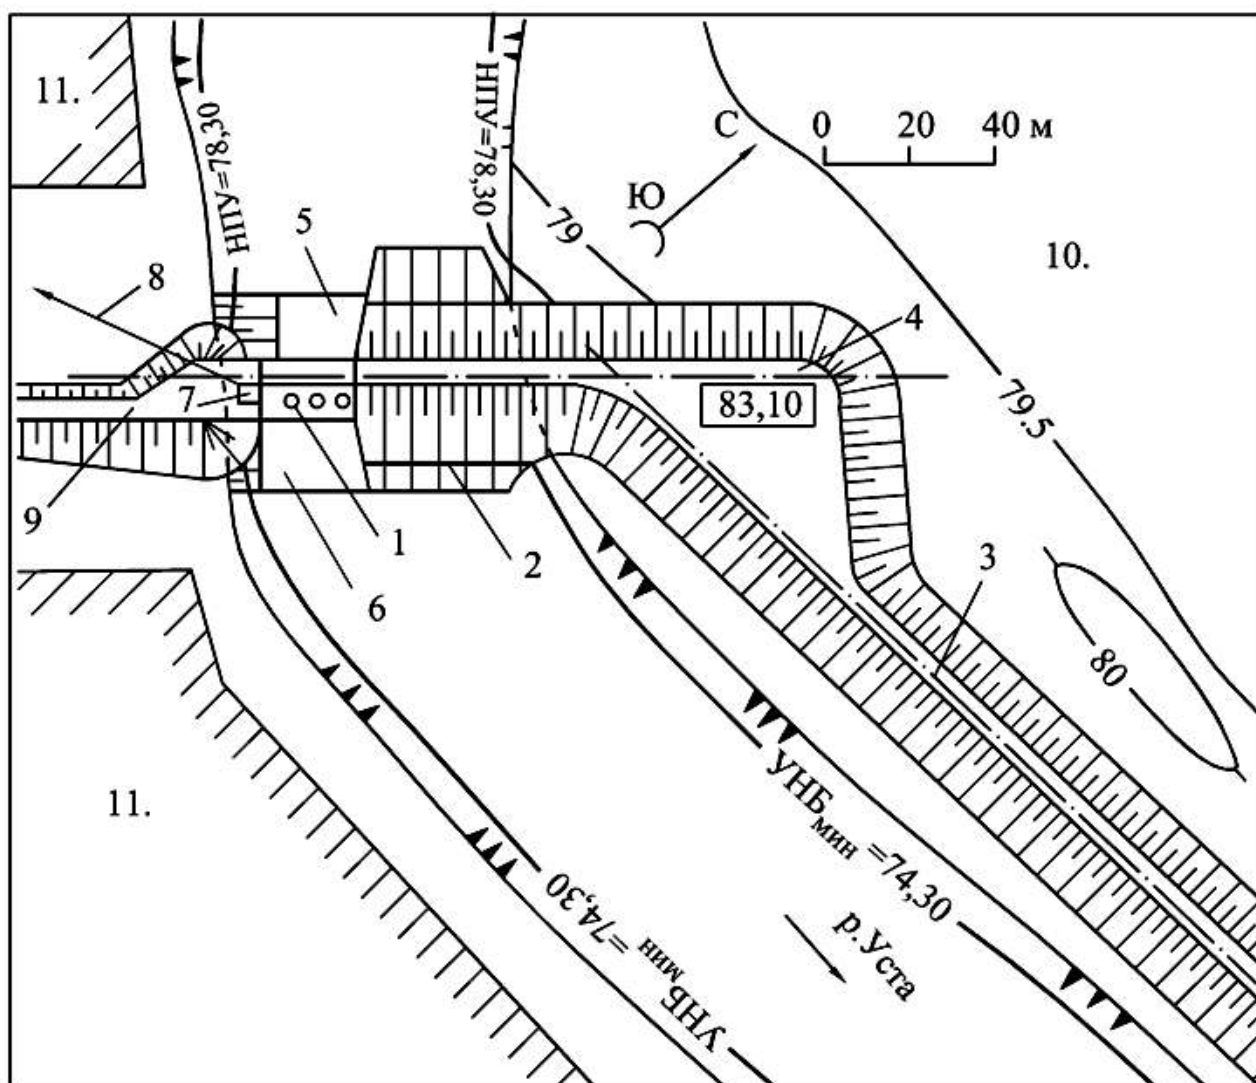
Генплан гидроузла на р. Уста (Нижегородская область):
